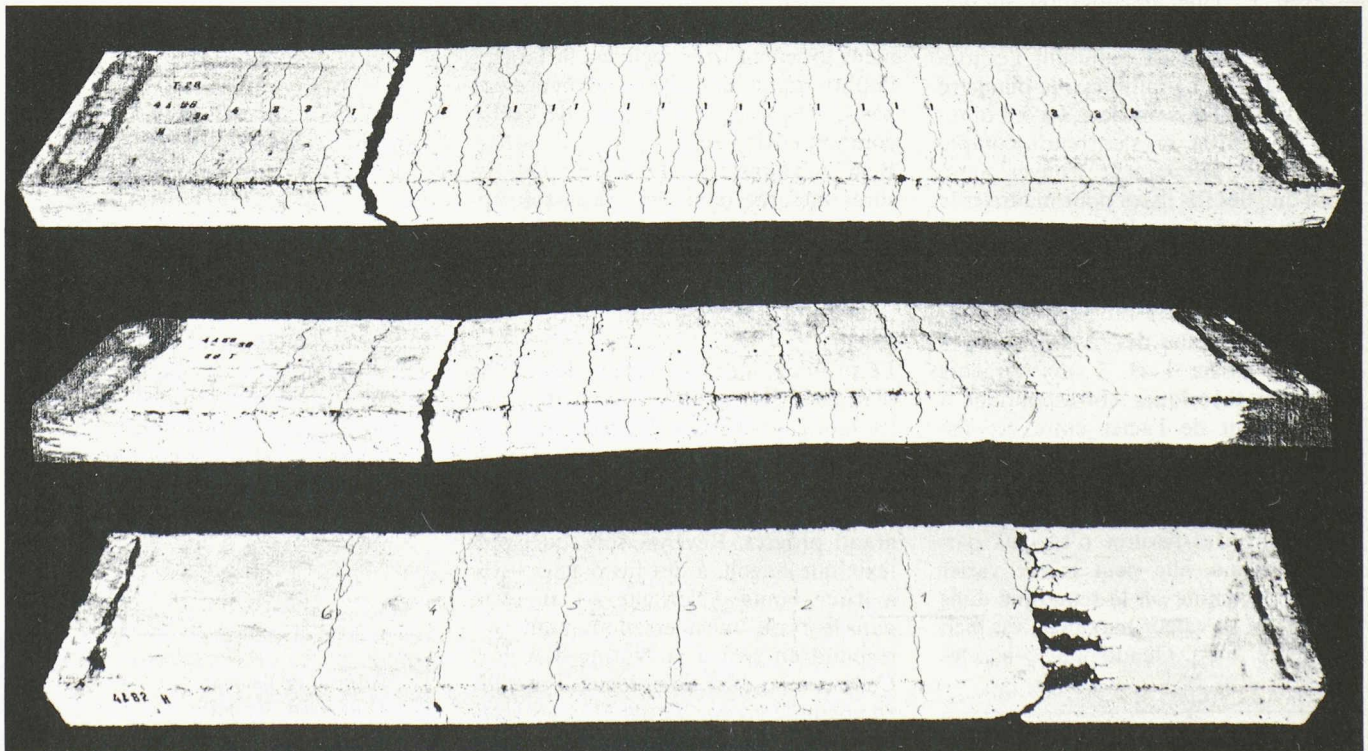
Etats de fissuration et de rupture des bandes de dalle, essais 1, 2 et 3.
